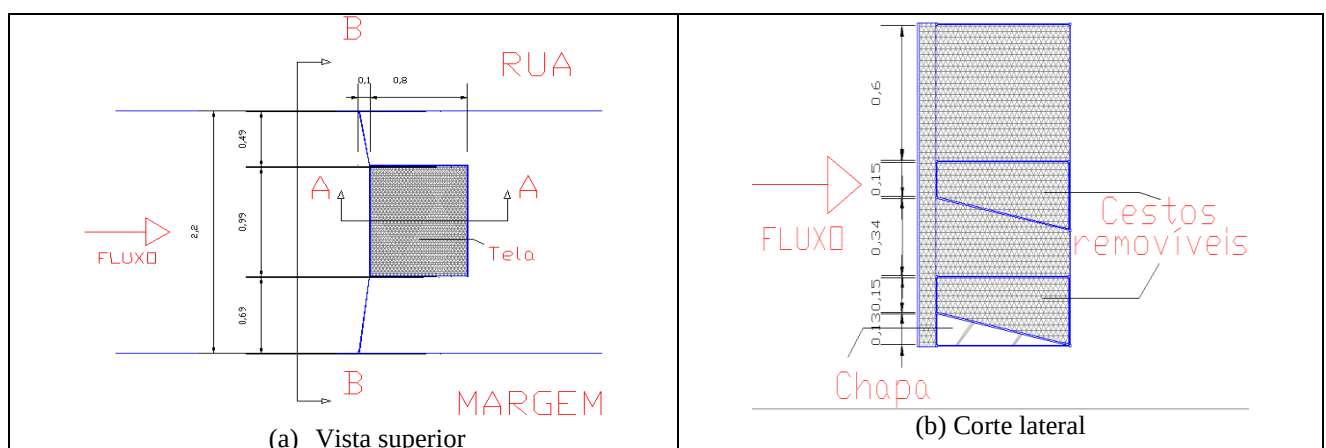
Vista superior e corte lateral do projeto da armadilha coletora de RSD.
